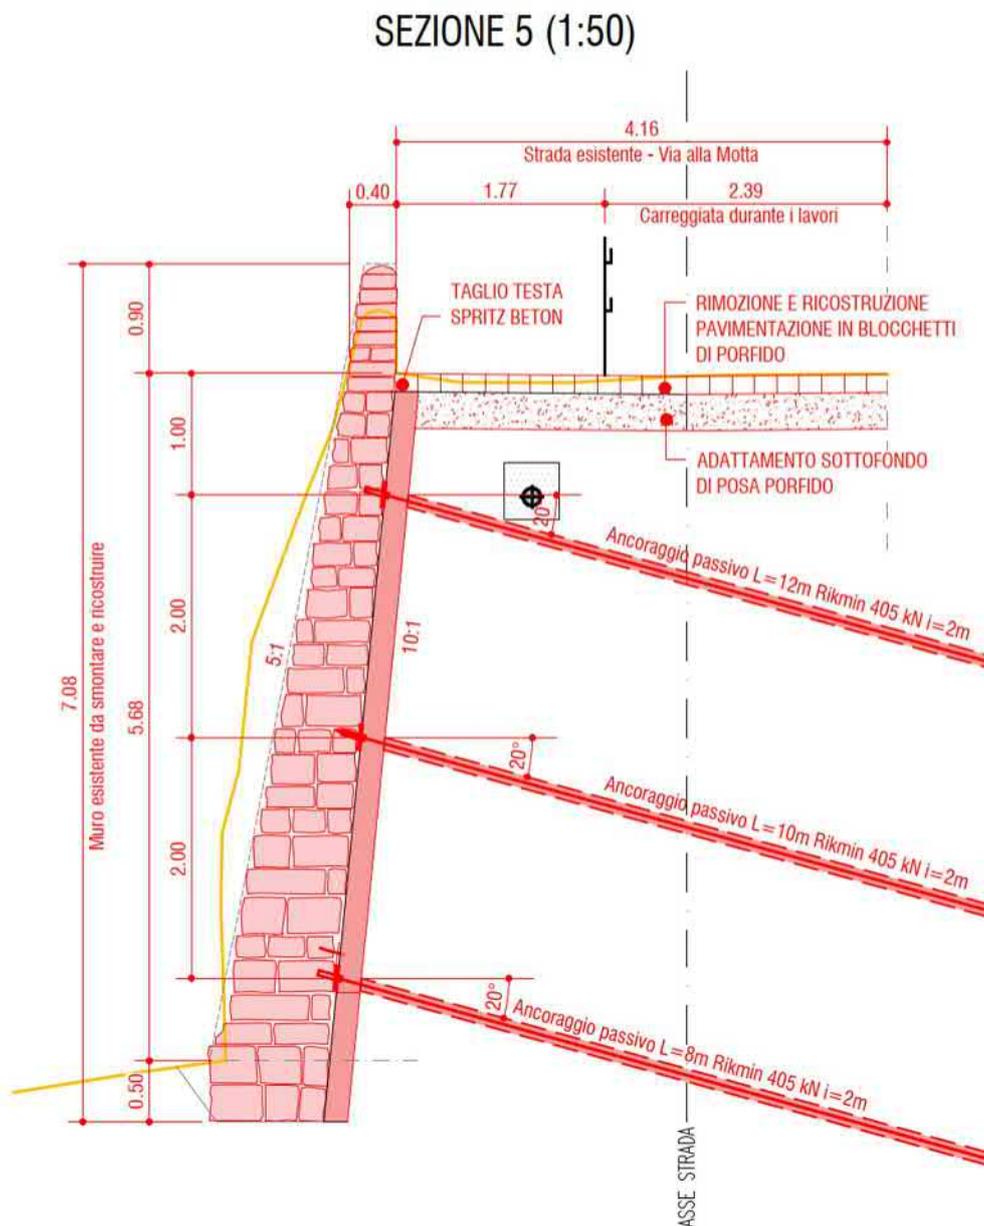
Sezione tipo - Rinforzo strutturale del muro di contenimento
